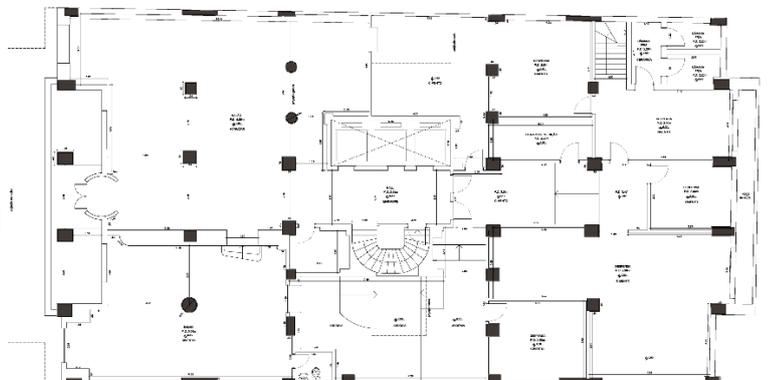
Planta térreo, levantamento do período de ocupação Fonte: COHAB
